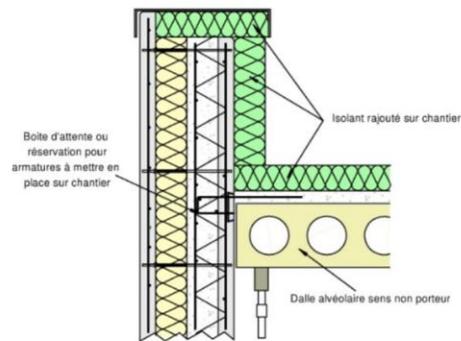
Plancher suspendu avec boîte d'attentes
